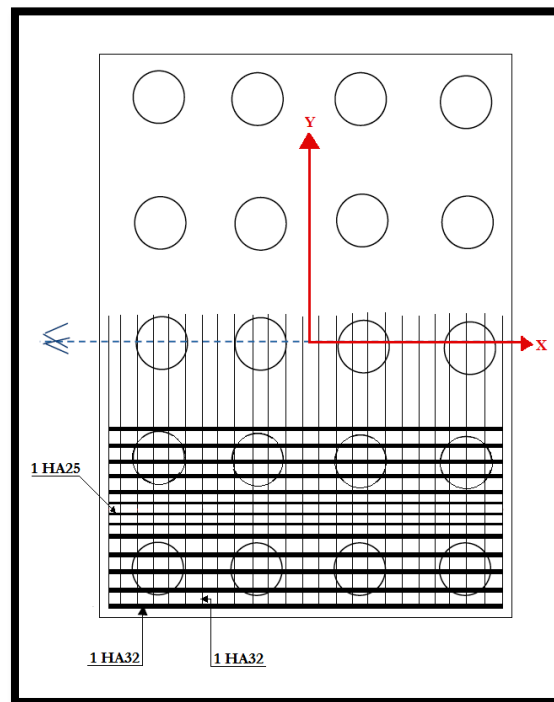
Ferrailage de la semelle (nappe inférieure)
